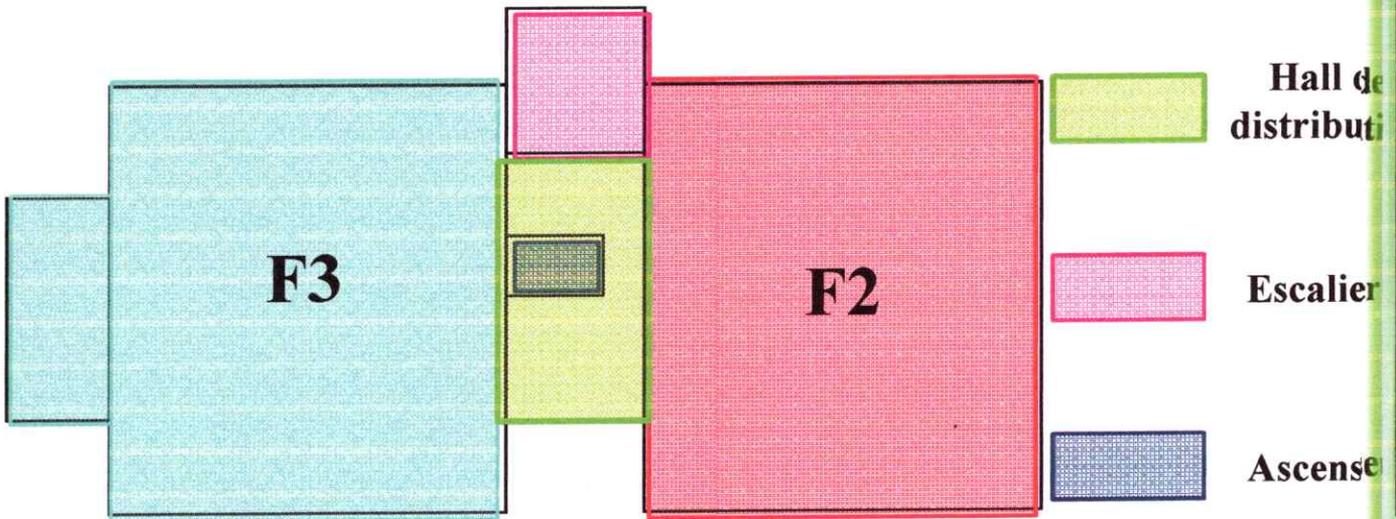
Plan (barre F2-F3) de REZ – DE –CHAUSSE
